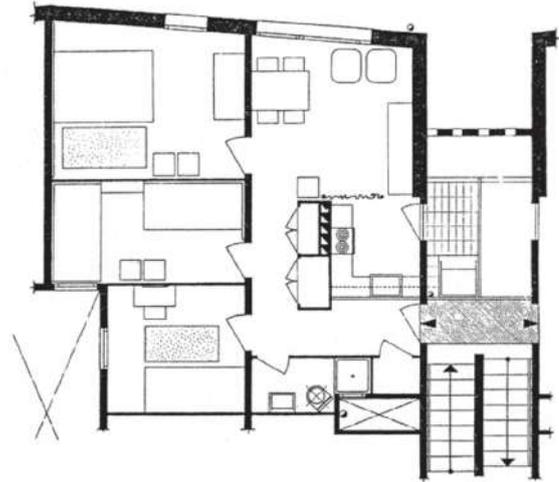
Plano de la planta tipo de la vivienda mínima de 60 m². Rodríguez, C. & Torres, J. Grup R.
